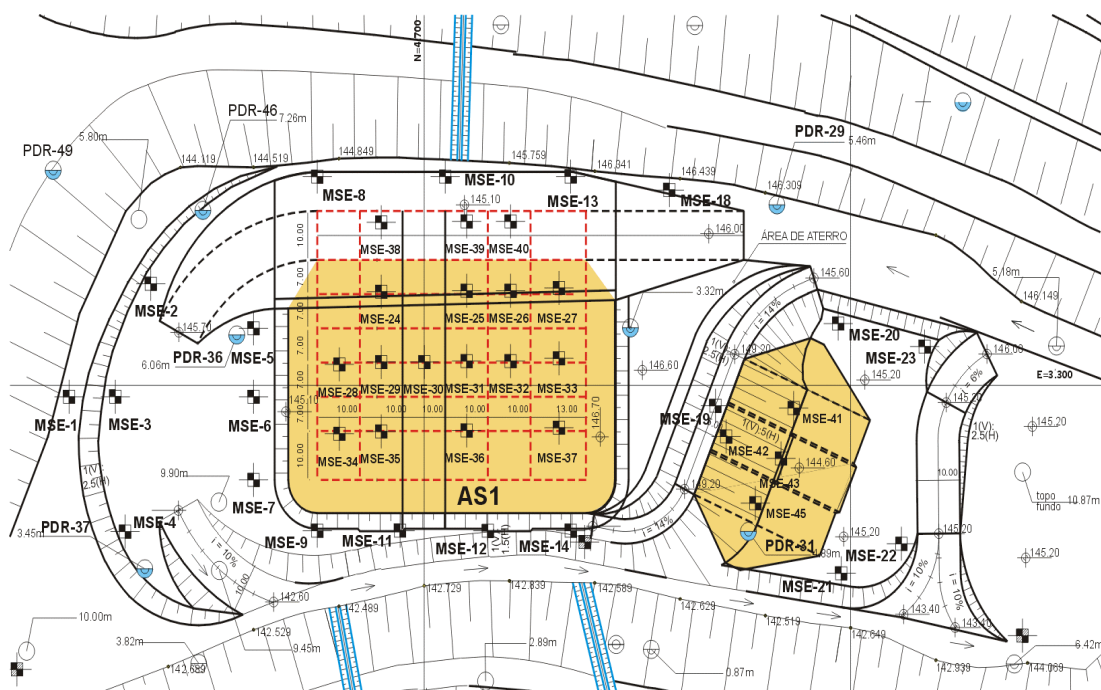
Localização da monitoração de 2ª fase nas praças de trabalho em plano horizontal e inclinado.
